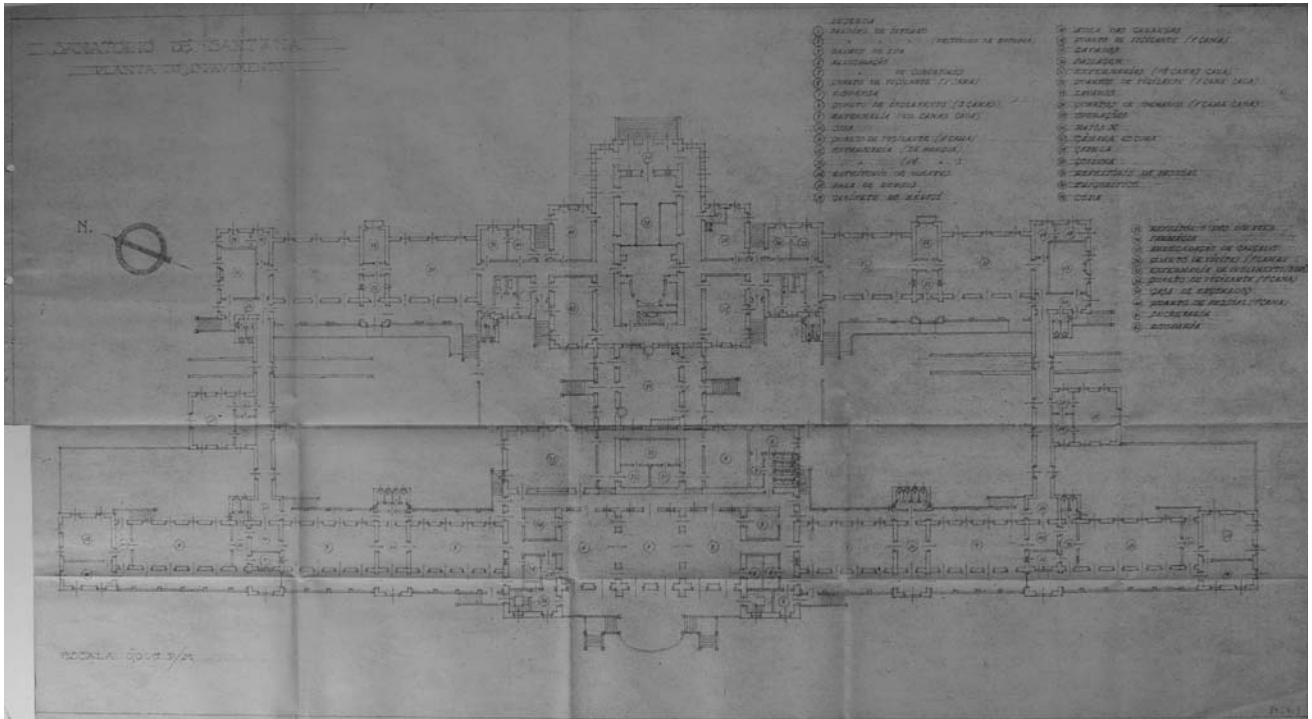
Planta do 1º Pavimento. SIPA: DES\_815403.
